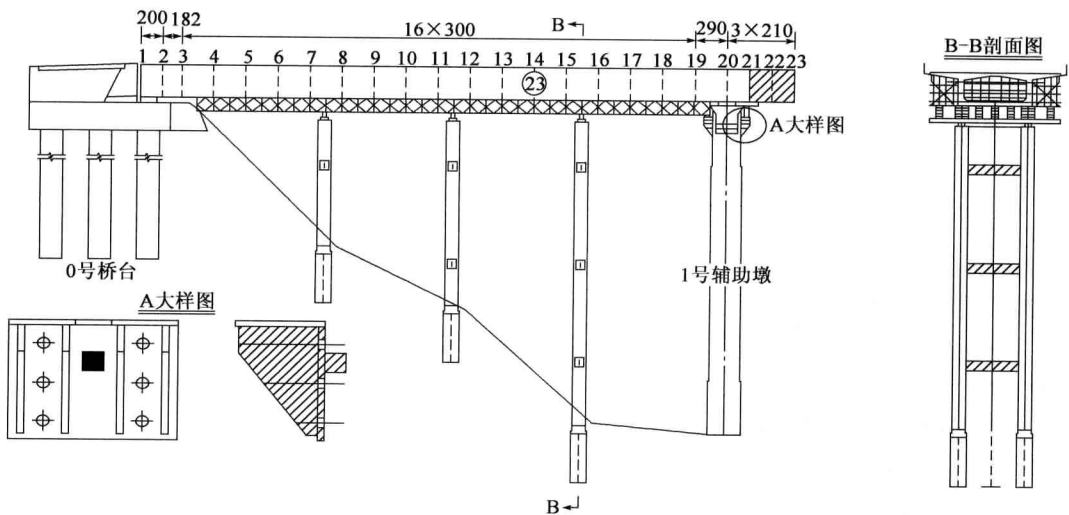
黑石沟特大桥边跨现浇段钢筋混凝土立柱支架立面图(尺寸单位:cm)
